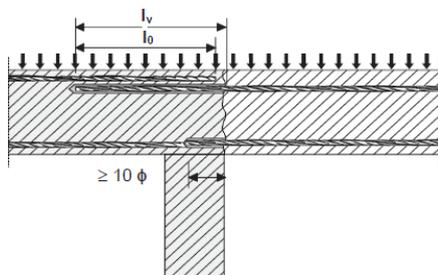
Jonction par recouvrement d'armatures pour la liaison de dalles et de poutres, d'après le DEE 330087-02-0601 [1]
